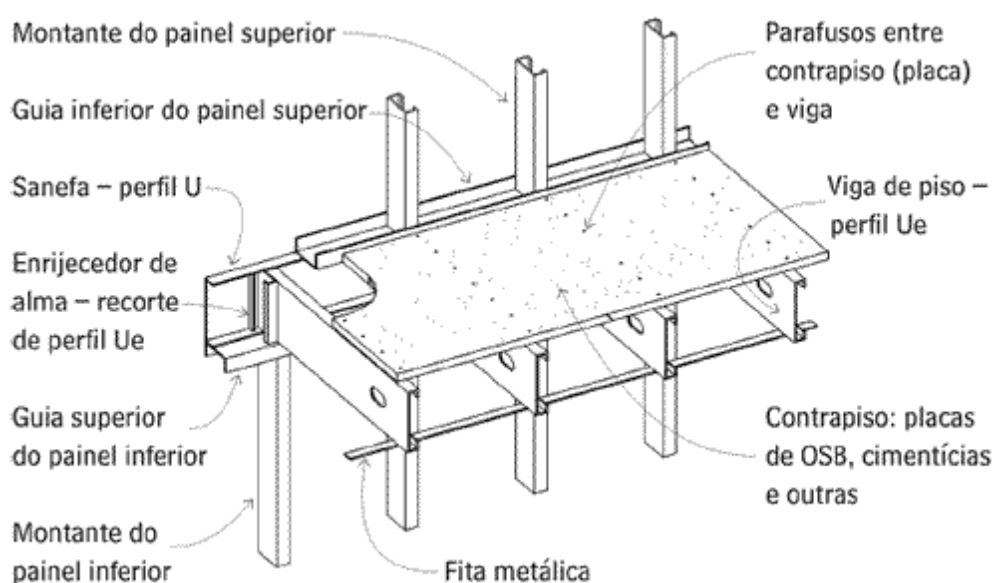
Lajes do tipo seca em estrutura do tipo LSF.
